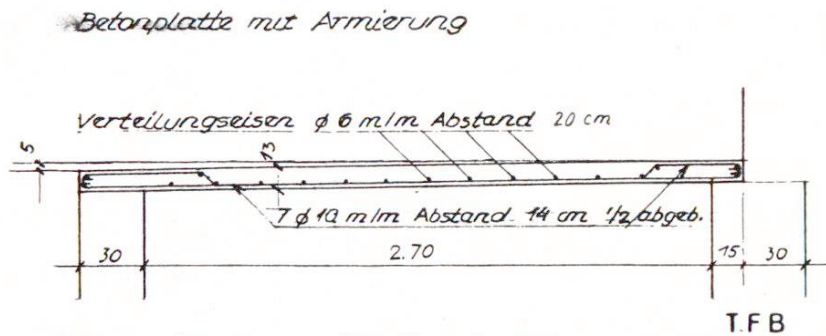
Dalle en béton armé recouvrant la fosse à purin
